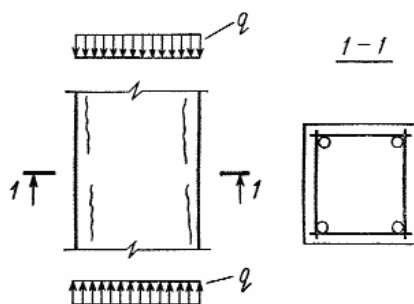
Трещины вдоль продольной арматуры в сжатых элементах.
